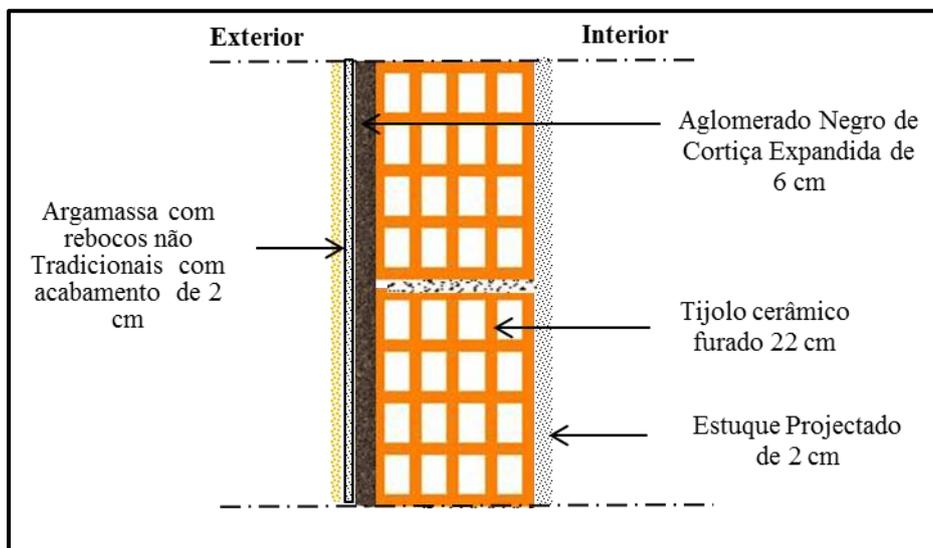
Pormenor Construtivo - PE com isolamento pelo Exterior – ICB
